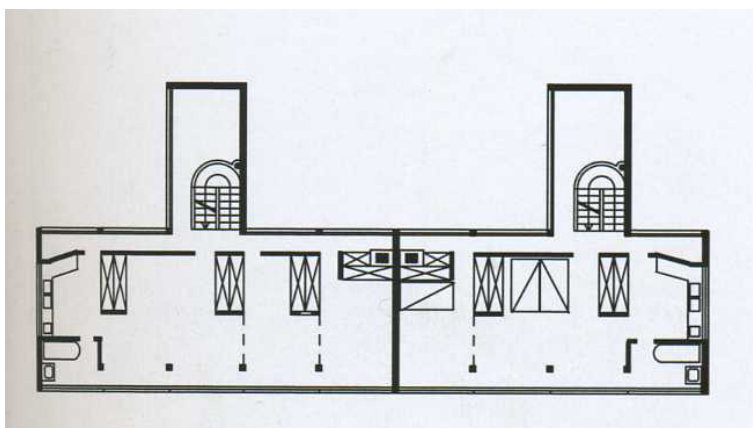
Planta do primeiro piso da *Double House* - Fonte
